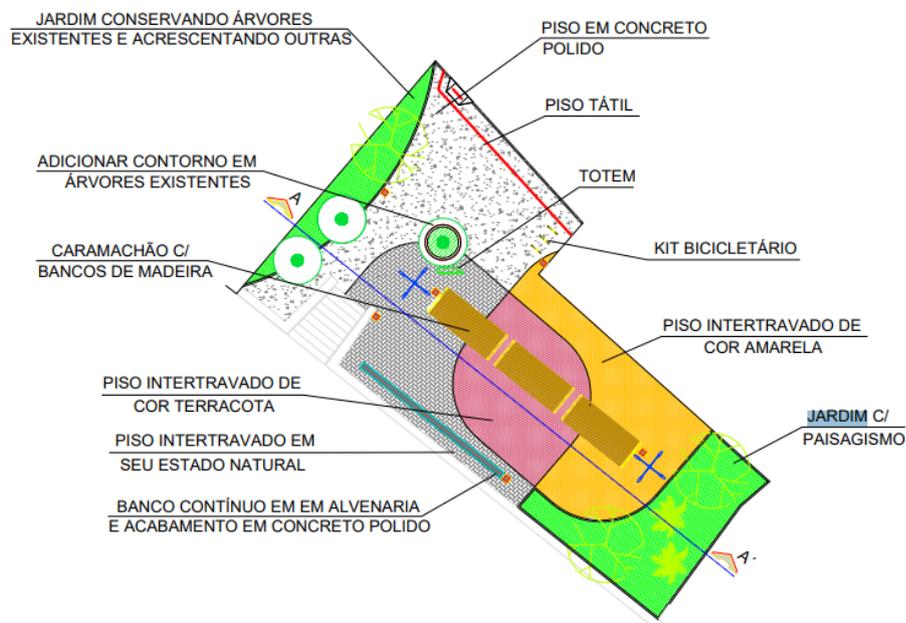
Planta arquitetônica da Orla Pontal de Coruripe
